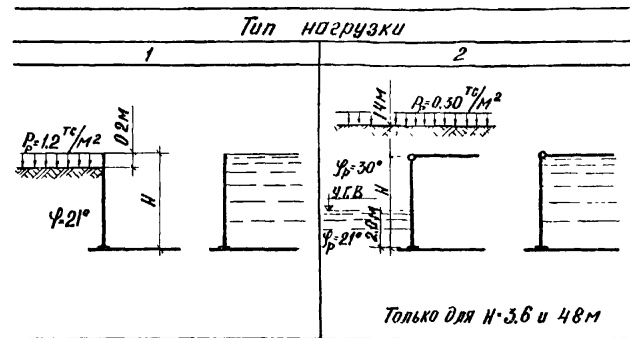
Схемы расчетных нагрузок на стены цилиндрических сооружений высотой 3,0 ± 6,0 м.
